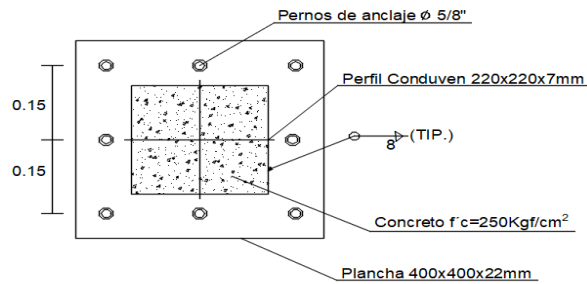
Detallado de sección de columna mixta rellena de concreto $f'c=250\text{Kgf/cm}^2$
